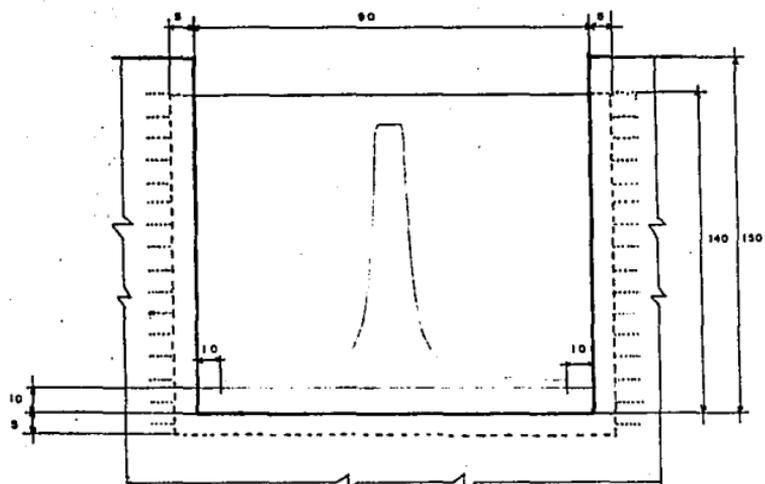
PLACA INSTALADA EN EL CANAL
